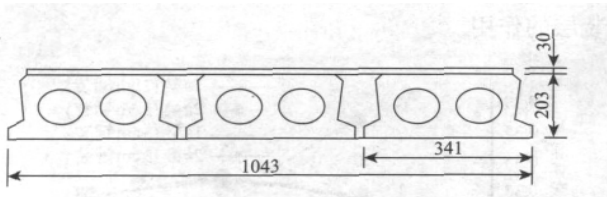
钢筋混凝土简支空心板梁横向一般布置图/mm
